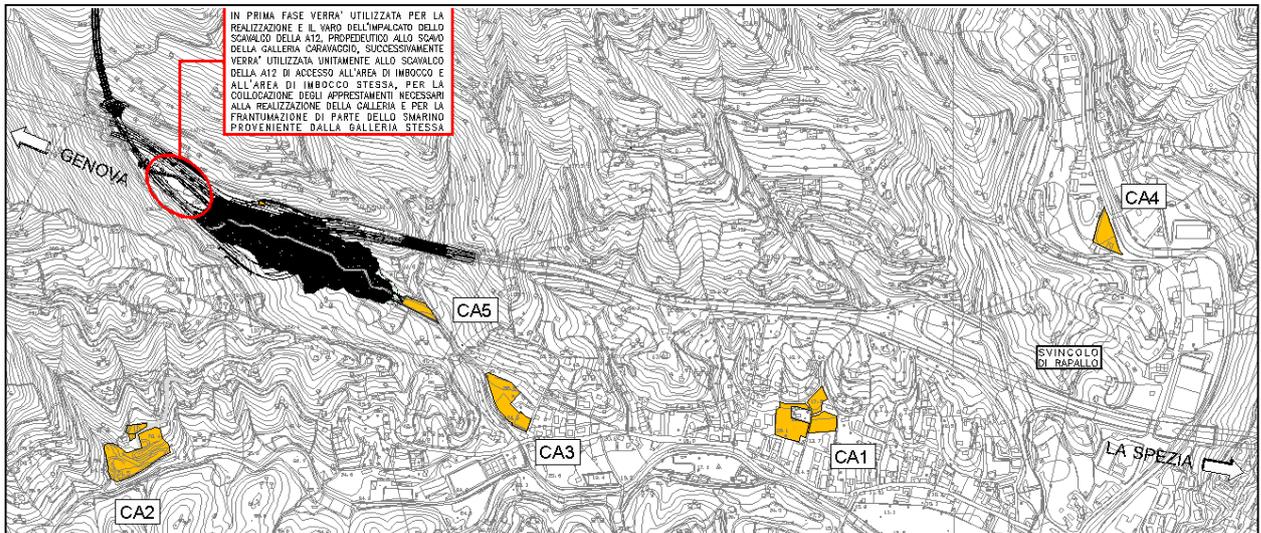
Aree di Cantiere – Ambito Rapallo
